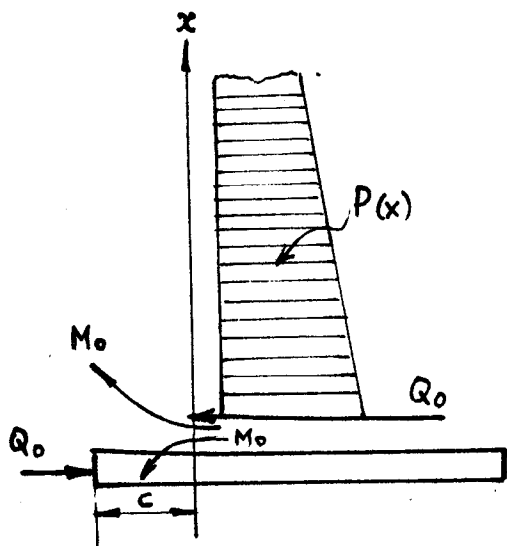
Розрахункова схема нижнього вузла резервуара
